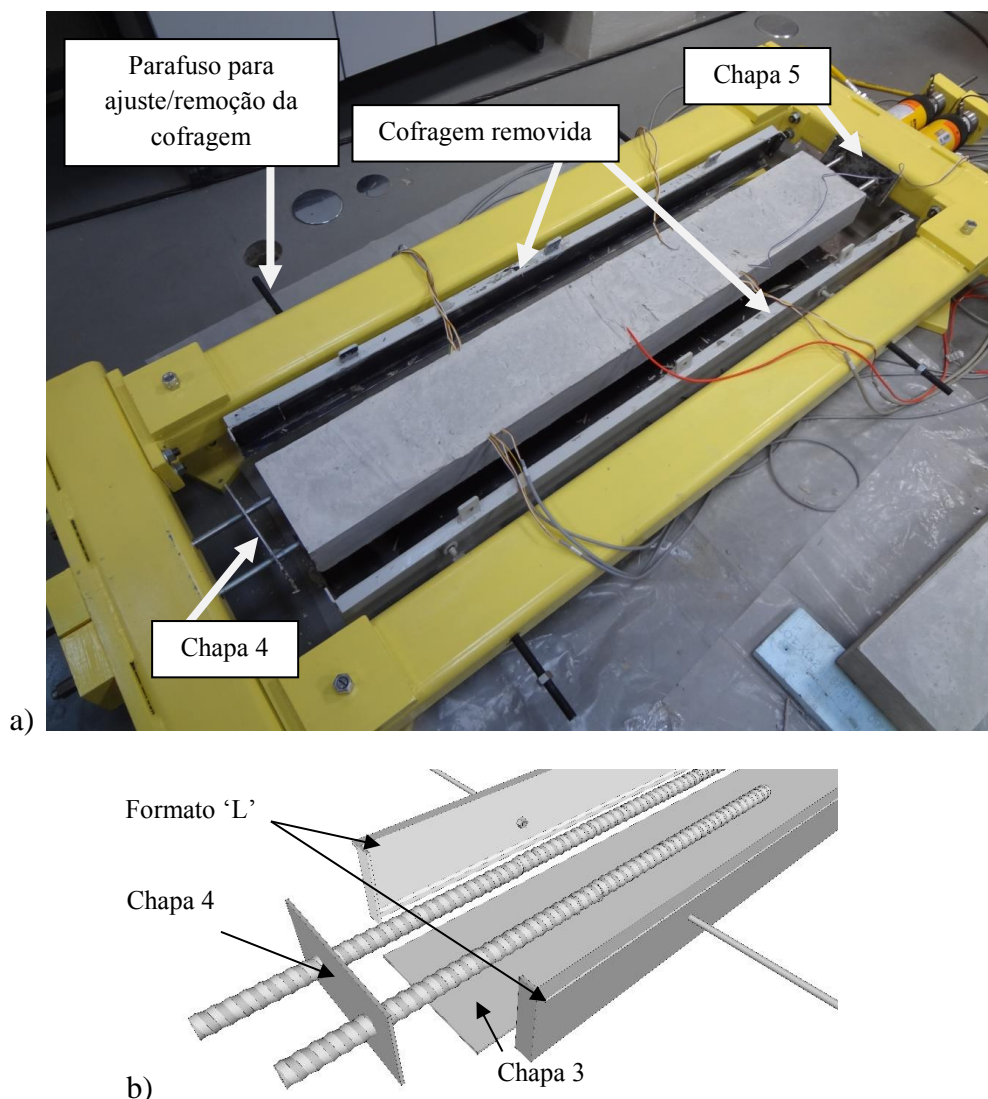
a) Provete restringido com a cofragem metálica removida; b) Detalhes da cofragem.
